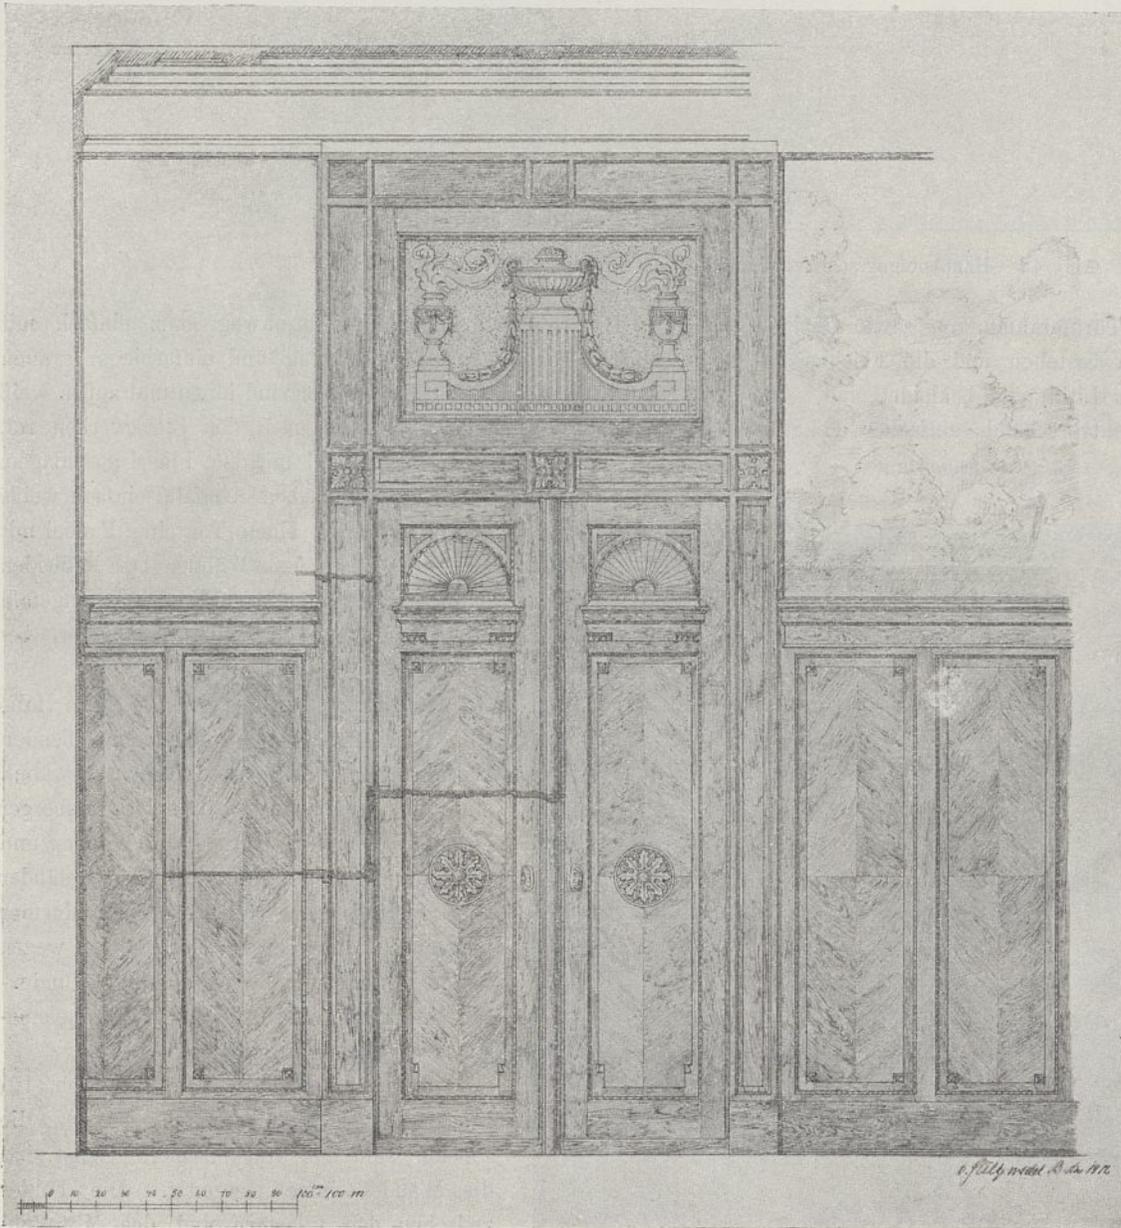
Wandbekleidung im Speisezimmer des Präsidenten.
